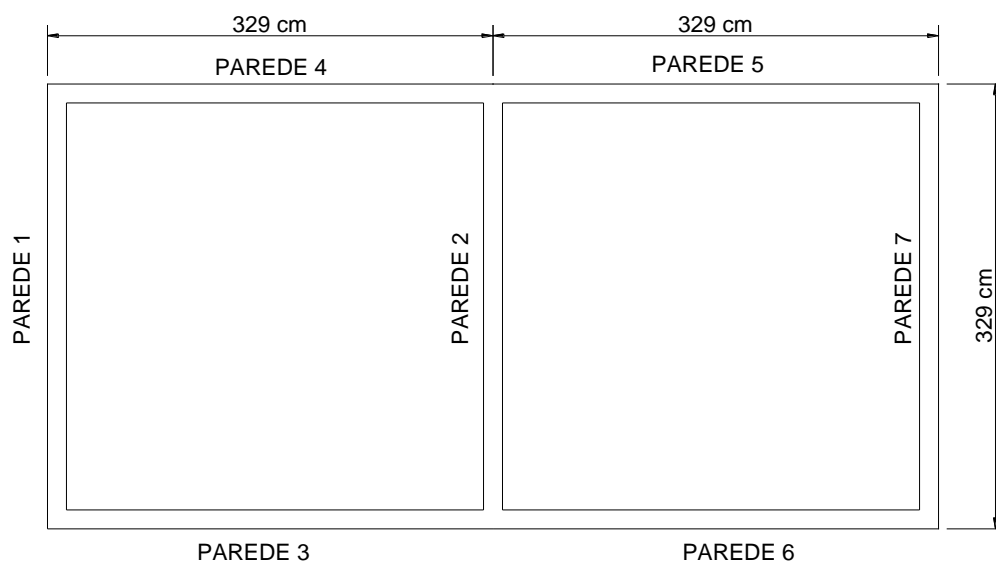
Croqui da planta baixa da estrutura de andares múltiplos
